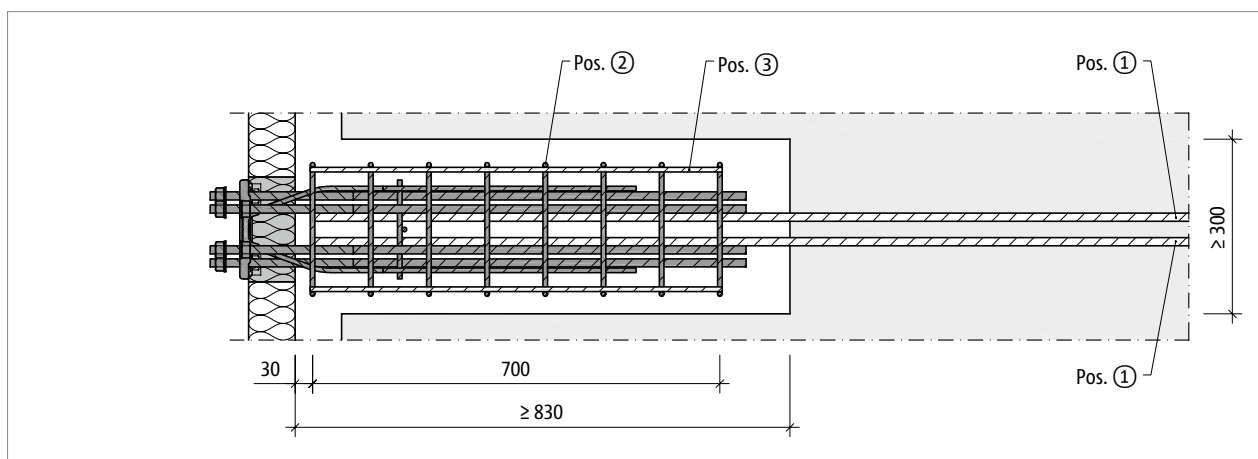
Schöck Isokorb® T type SK-MM1-VV1 : renforcement sur site pour mode de construction semi-préfabriqué, projection horizontale
